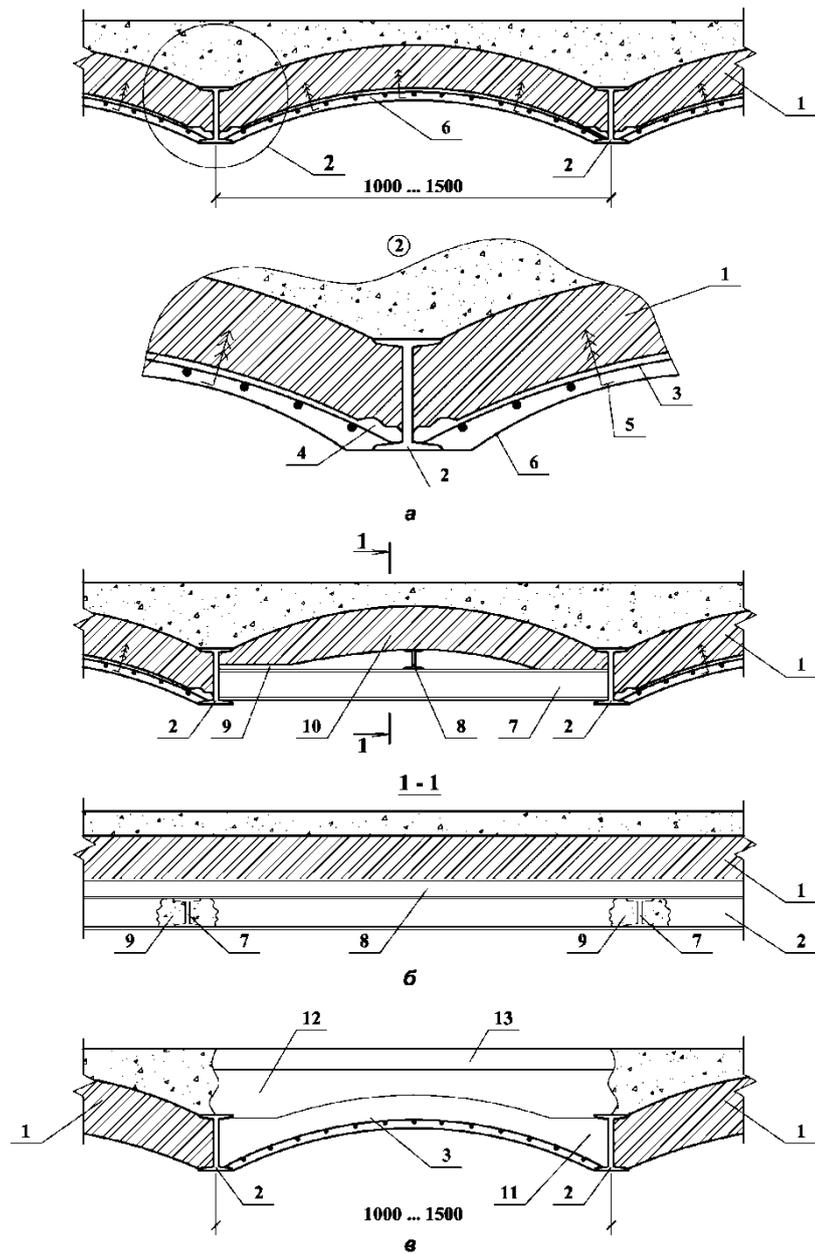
Усиление каменных перекрытий: а – наращиванием железобетонной арочной плиты снизу; б – подведением разгружающих стальных балок; в – устройством железобетонного арочного перекрытия взамен кирпичного; 1 – свод из каменной кладки; 2 – несущие стальные балки (двутавр, рельс); 3 – арматурная сетка; 4 – пазы в перекрытии для опирания железобетонного наращивания; 5 – анкеры (ерши) для крепления сетки, забитые в швы кладки; 6 – железобетонное наращивание в виде арочной плиты; 7 – разгружающие поперечные балки, опирающиеся на несущие балки перекрытия; 8 – разгружающие продольные балки; 9 – ниши в перекрытии (после установки разгружающих балок заделать раствором); 10 – пространство между перекрытием и разгрузочными балками, заложённое каменной кладкой; 11 – арочное железобетонное перекрытие, выполненное вместо кирпичного; 12 – засыпка из керамзитового гравия; 13 – восстановленный пол
